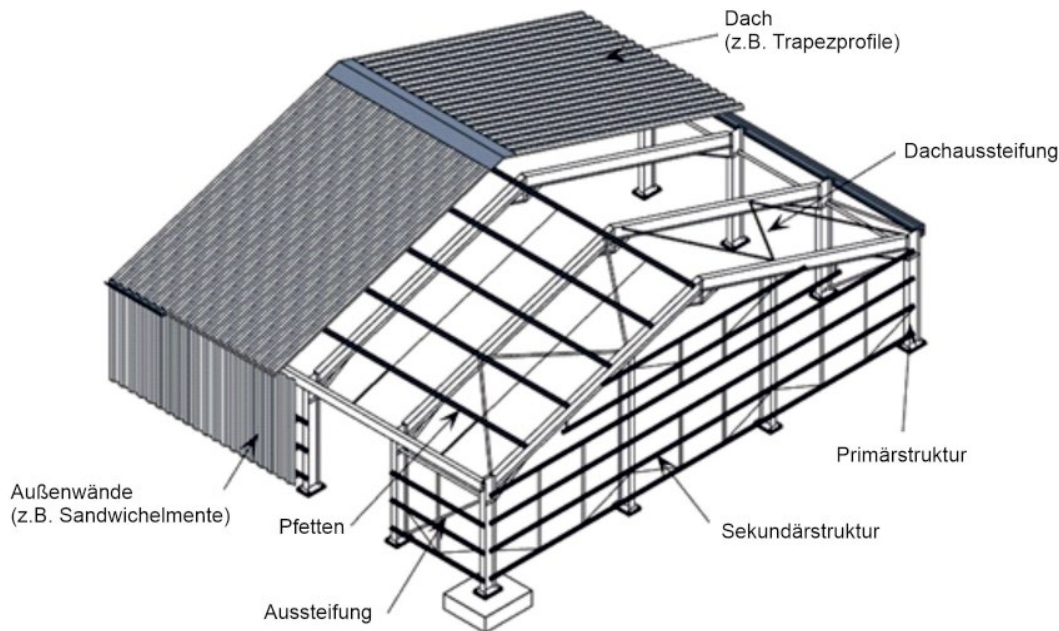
Grundlegende Komponenten von eingeschossigen hallenartigen Gebäuden in Stahlbauweise [3]
